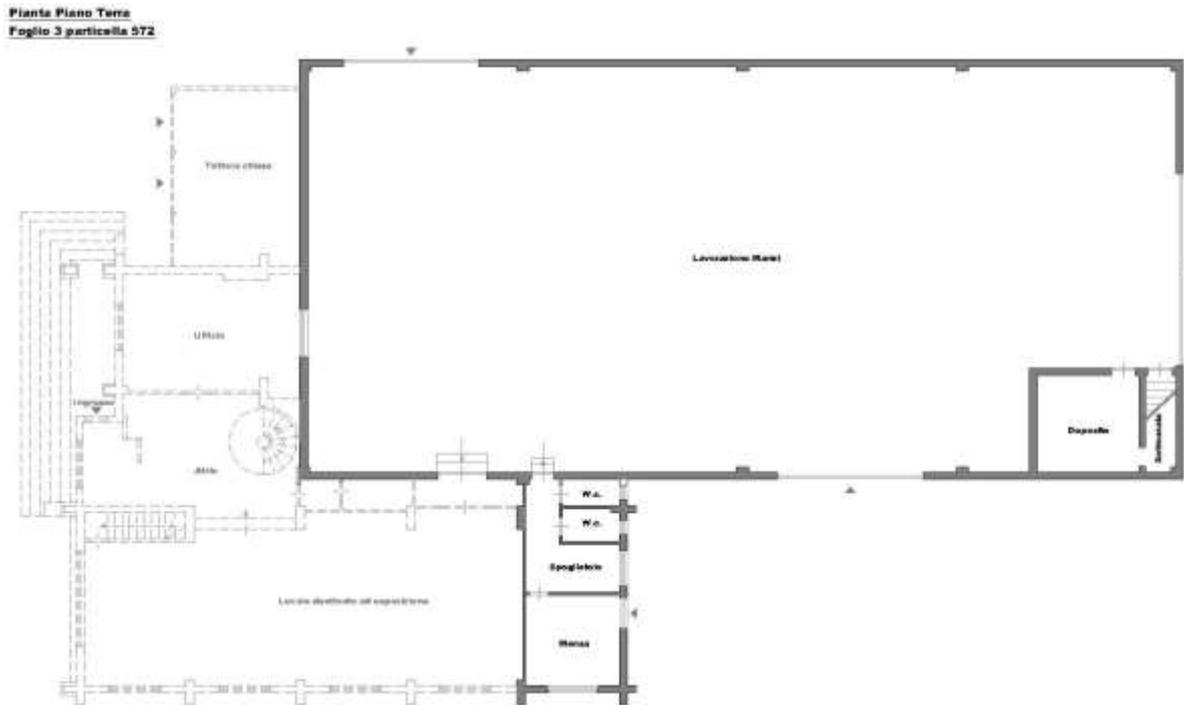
Pianta Piano Terra_Corpo 1 "Capannone"
